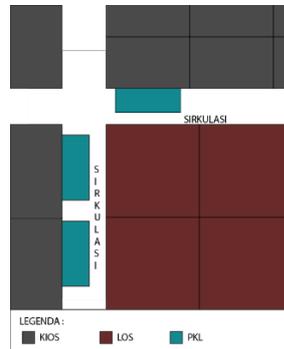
Kondisi Lahan Ruang yang berfungsi ganda pasar Anyar.
